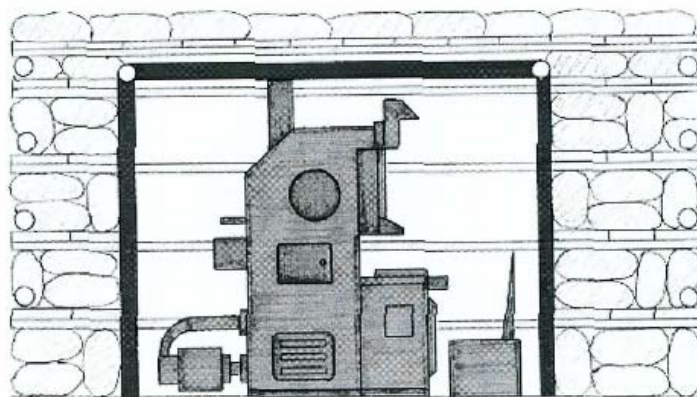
Вариант укрытия уникального оборудования, позволяющий продолжать работу
